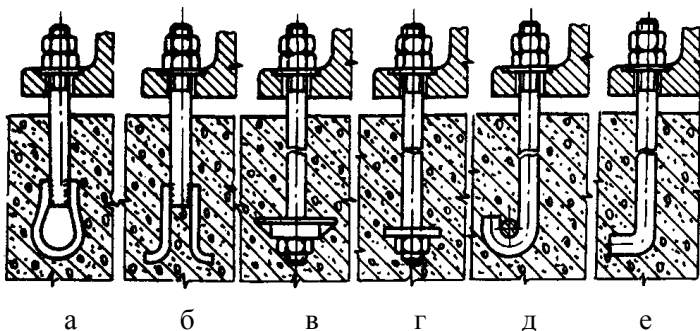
Глухі анкерні болти встановлювані до бетонування фундаментів
